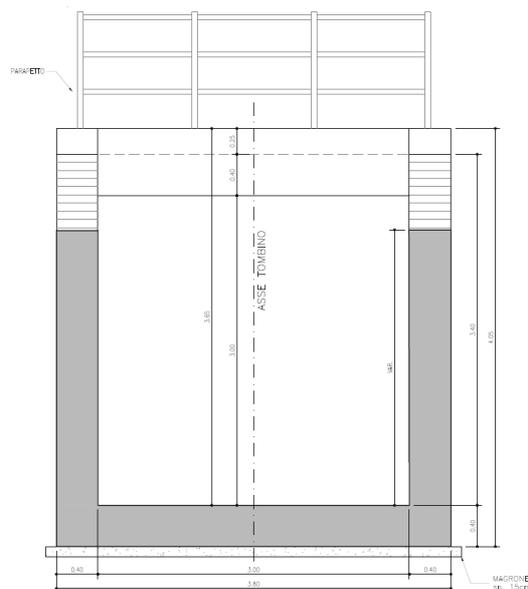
Manufatto di sbocco - Sezione trasversale
